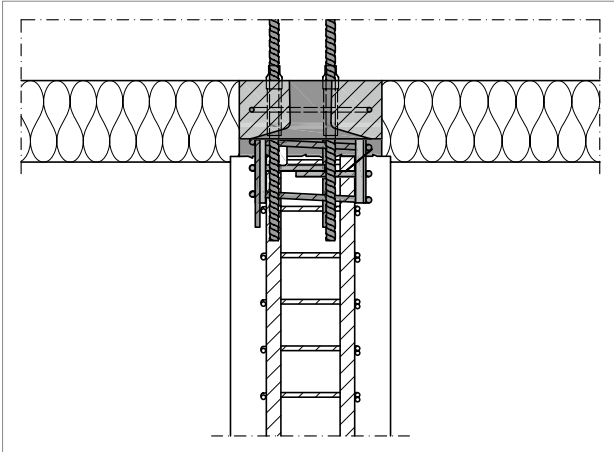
Schöck Sconnex® Typ P: Bewehrungsführung im Bereich 1 – Stützenlängsschnitt
